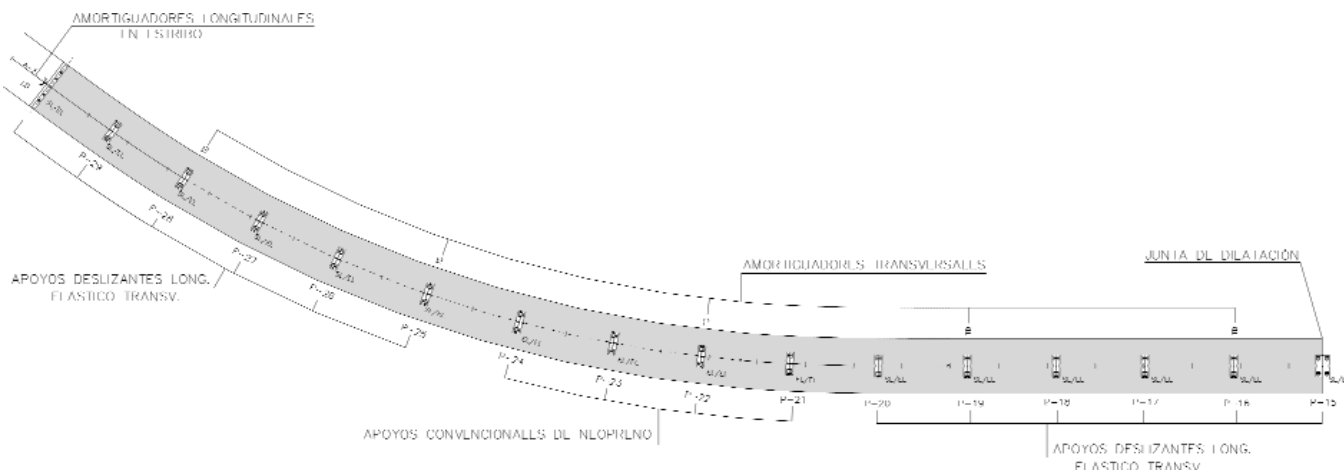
Esquema en planta de un semi-tablero correspondiente a una calzada.
